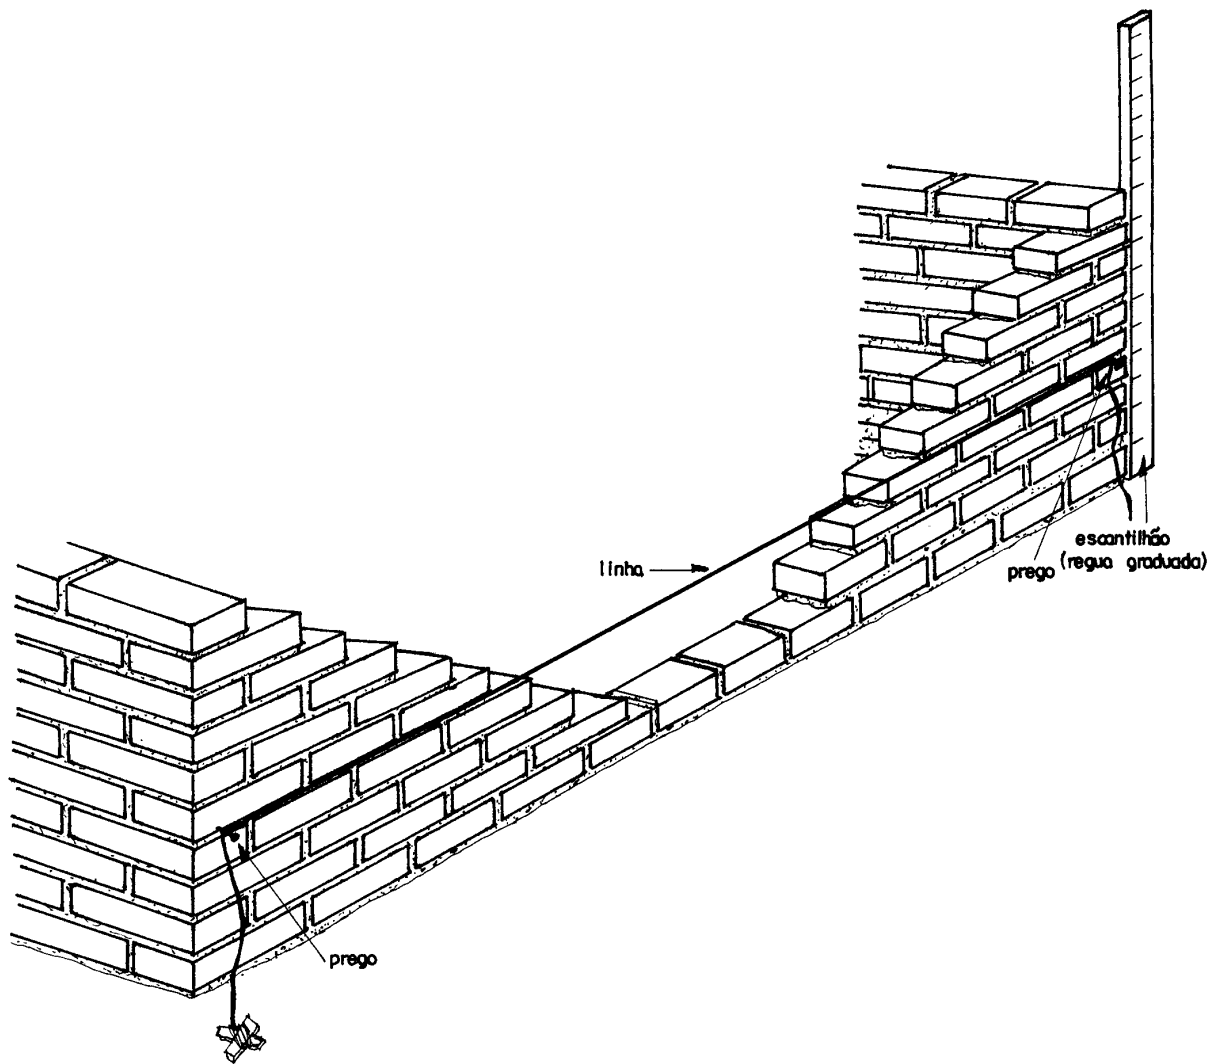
Detalhe do nivelamento da elevação da alvenaria
